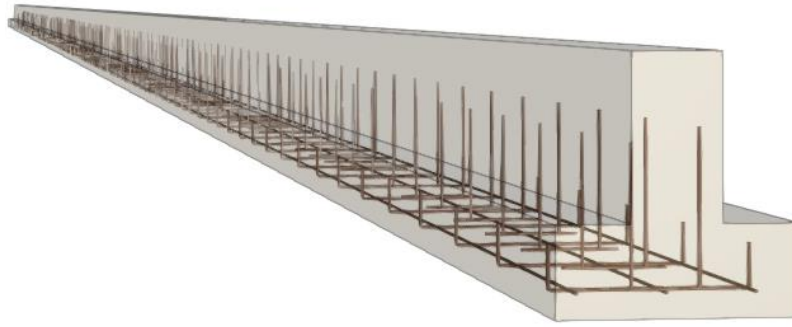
Vista 3D de la zapata corrida bajo muro M1
